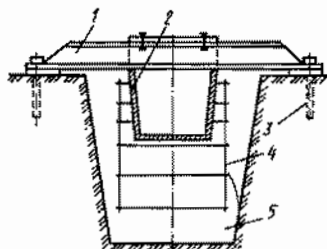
Установка в котловане опалубки стакана фундамента и его арматурного каркаса перед бетонированием: 1 - рама; 2 - опалубка стакана; 3 - штыри; 4 - арматурный каркас; 5 - вытрамбованный котлован
